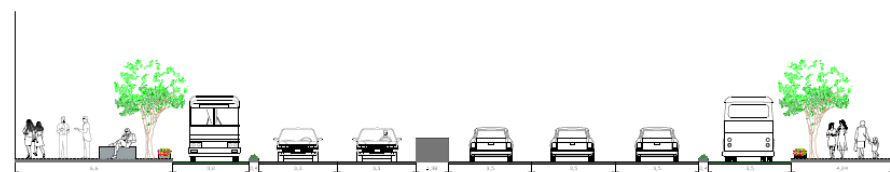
Planta y sección Avenida del Ejército, tras la intersección de la Casa del Mar.
